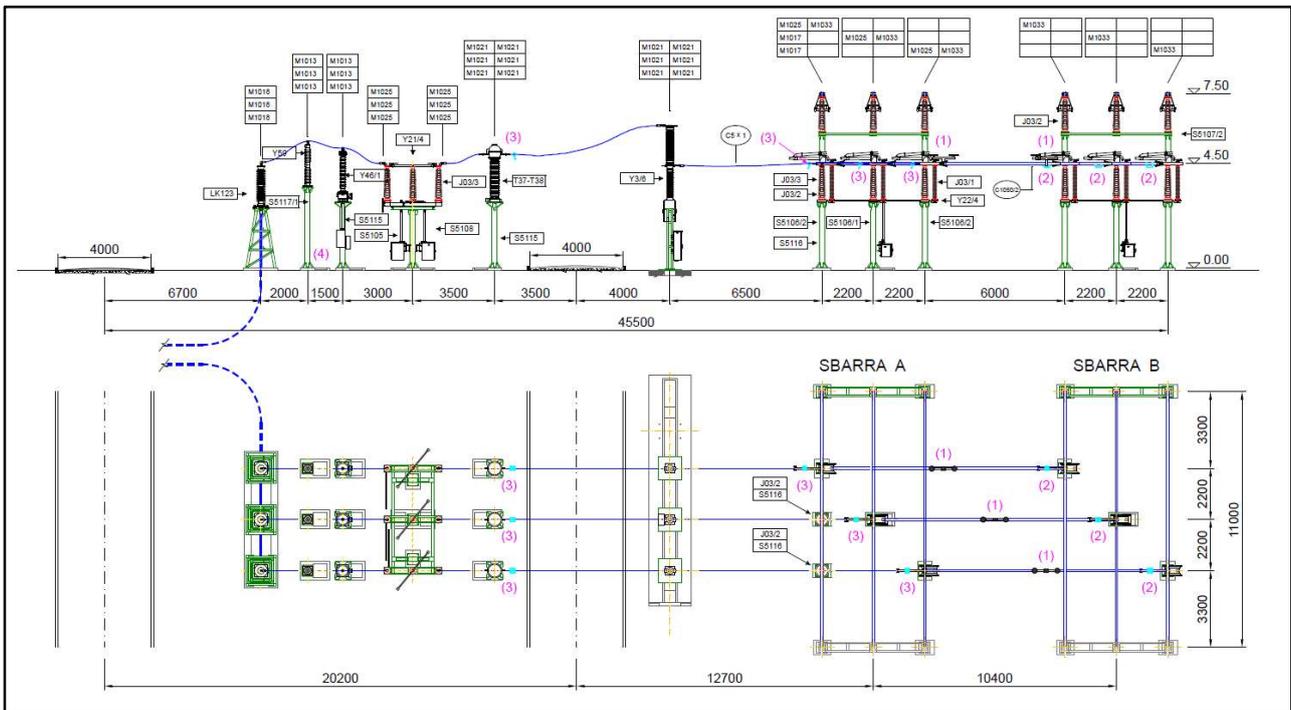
Planimetria e sezione elettromeccanica relativa alle apparecchiature dello stallo 150 kV nella stazione Terna
